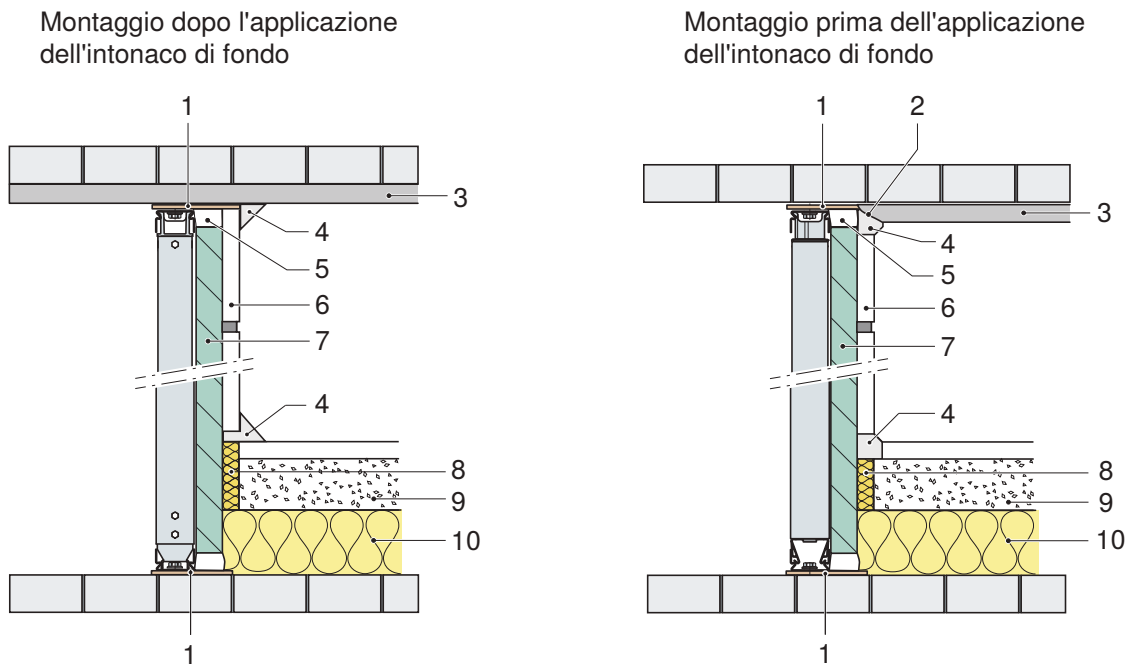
Sistema Geberit Duofix nella versione con montaggio prima e dopo l'applicazione dell'intonaco di fondo
